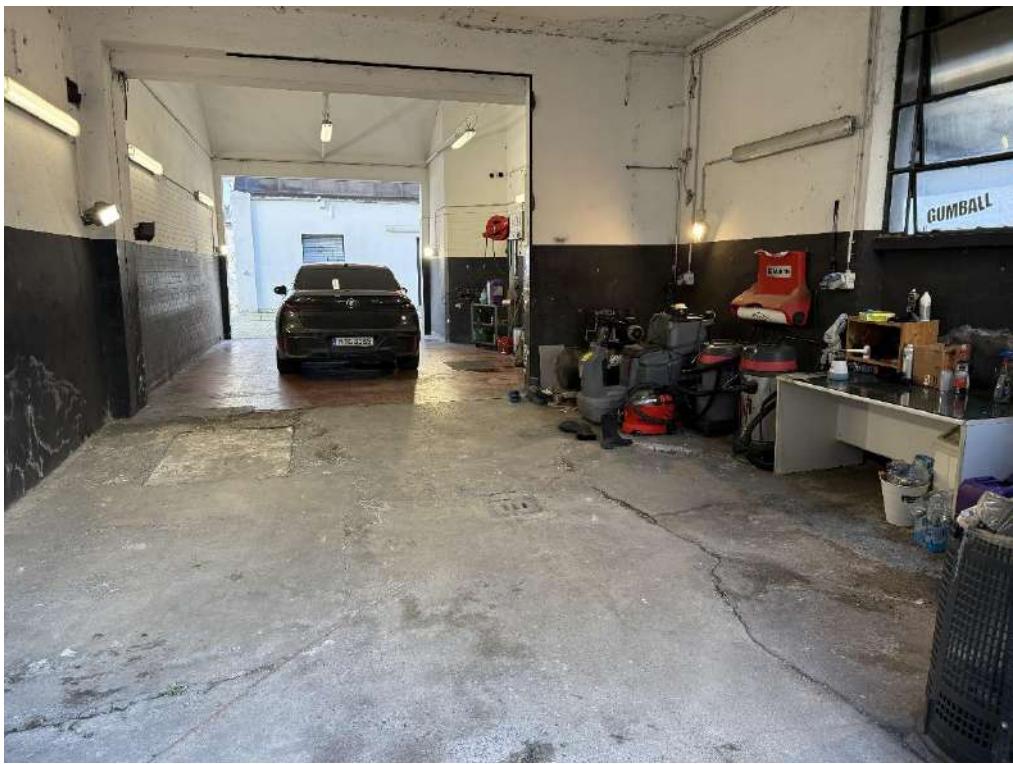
DEPOSITO ZONA LAVAGGIO
